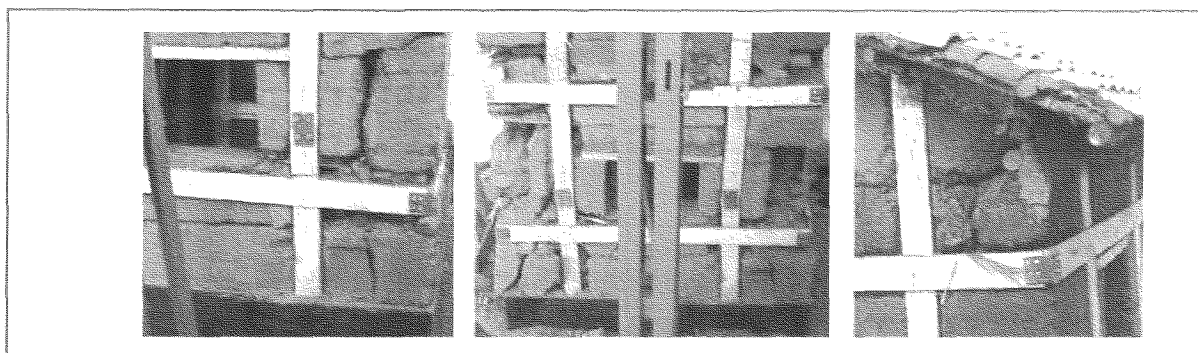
Principales grietas y deterioro de primer nivel – Vivienda IV
